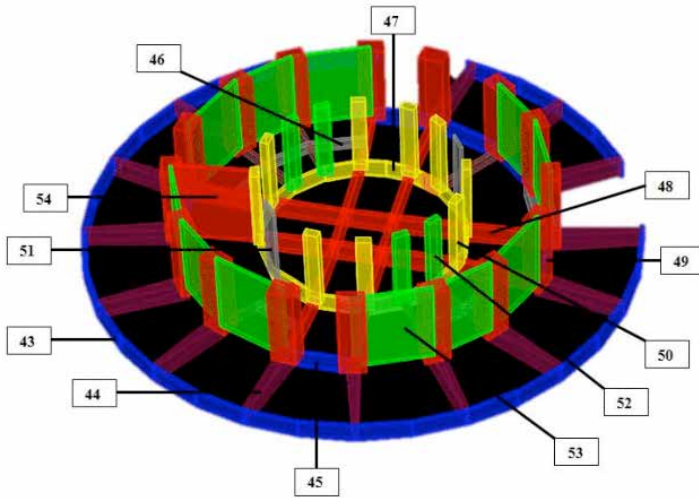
Elementos estruturais do mezanino modelados, bloco A.
